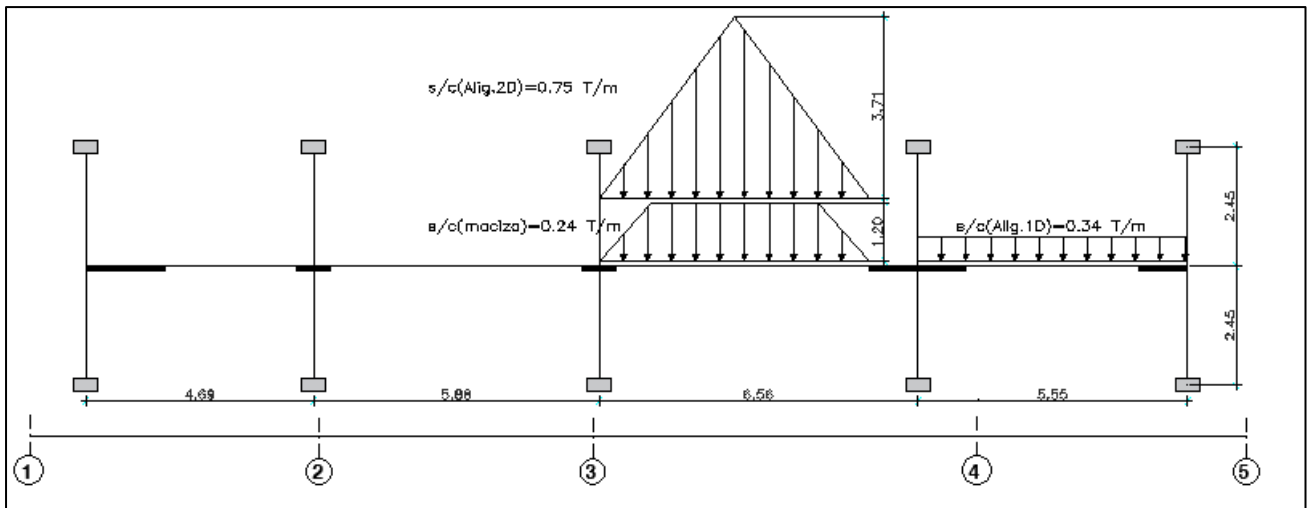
Metrado de carga viva en viga VT- 6.
